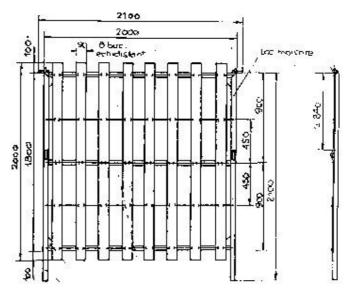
Panou mobil de parazăpezi din metal pe cadru din cornier.
